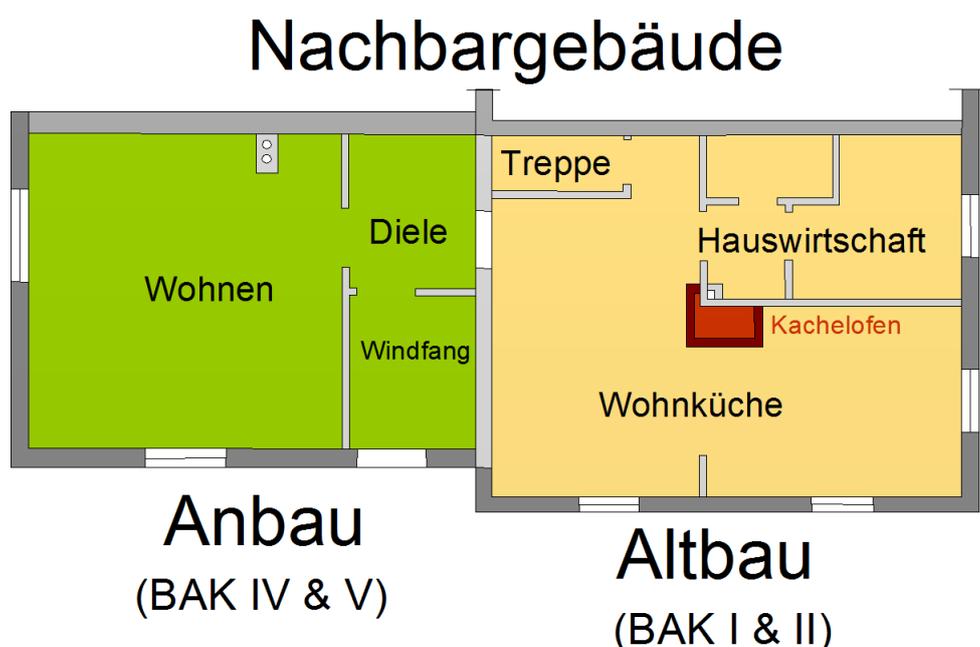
EG-Grundriss des Referenzgebäudes Lichteneiche
